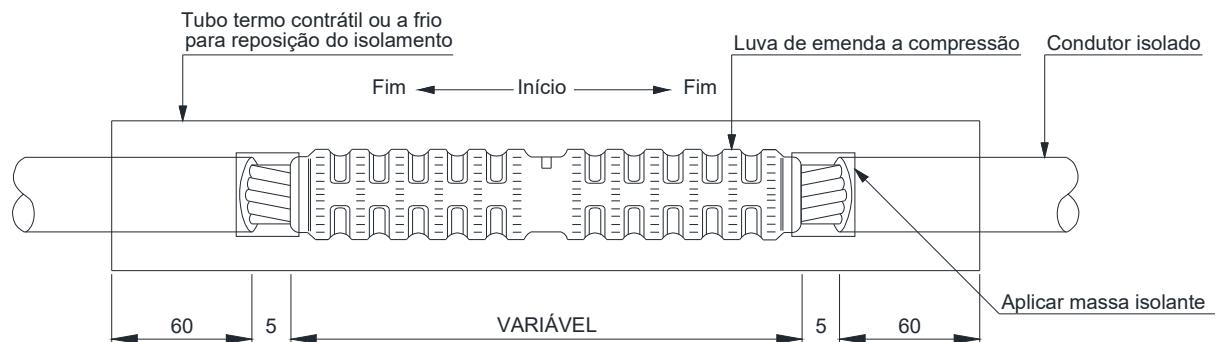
Conexões e emendas – Emenda de cabo de alumínio protegido – Construção
